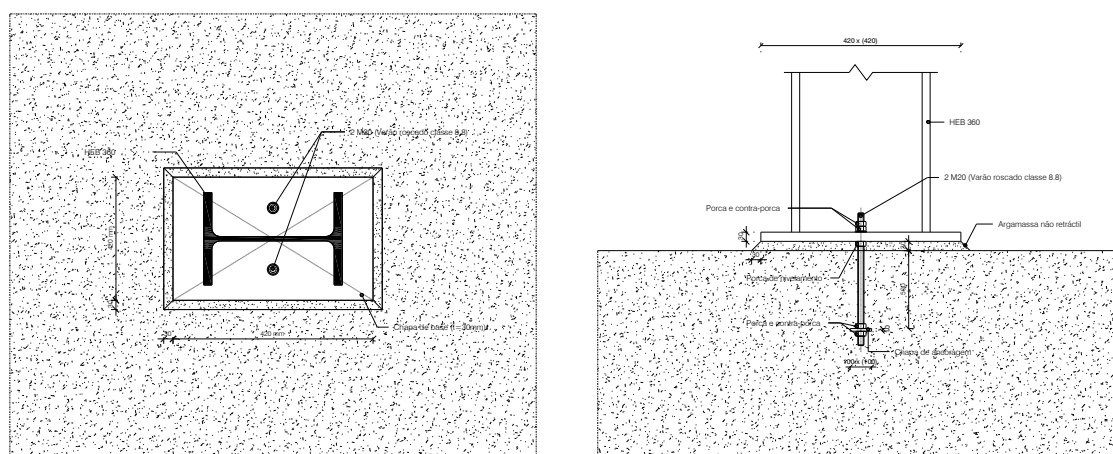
Pormenor construtivo da ligação do tipo 1. [SE2P]
